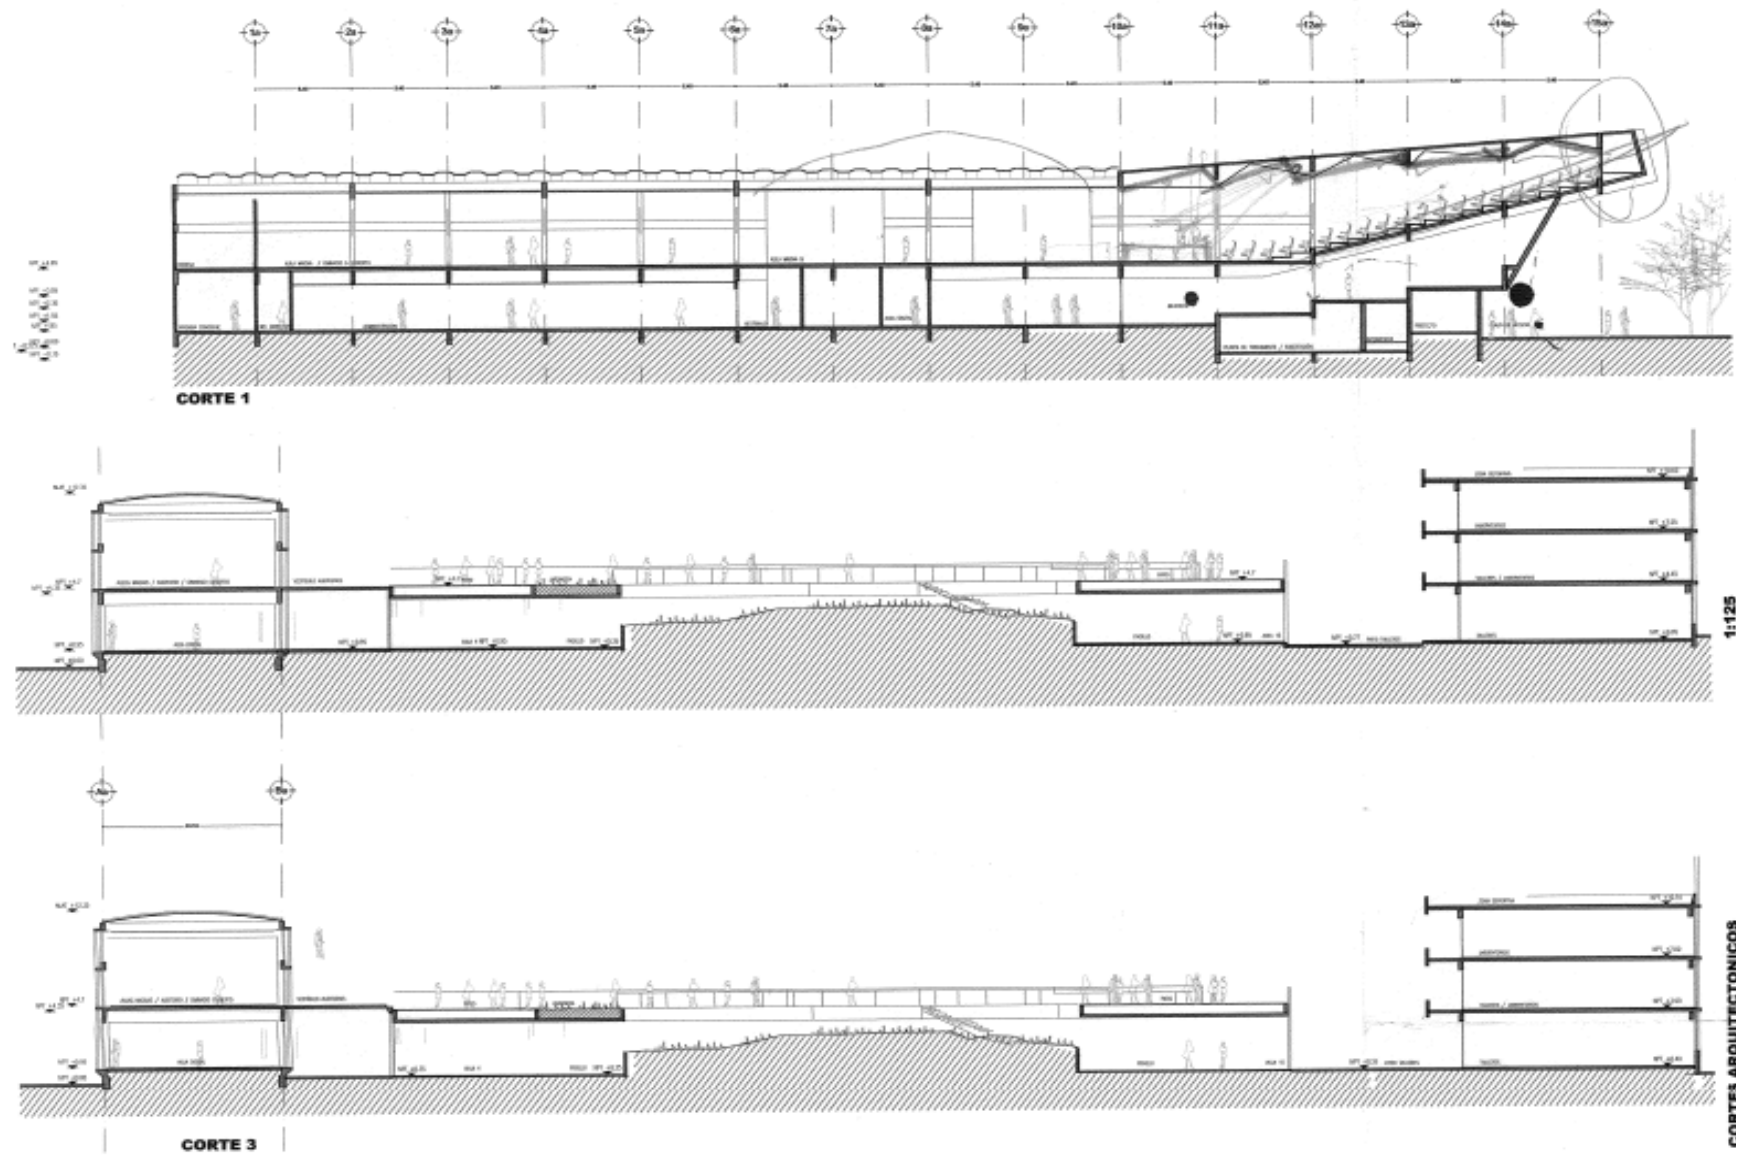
Cortes arquitectónicos del nuevo proyecto
